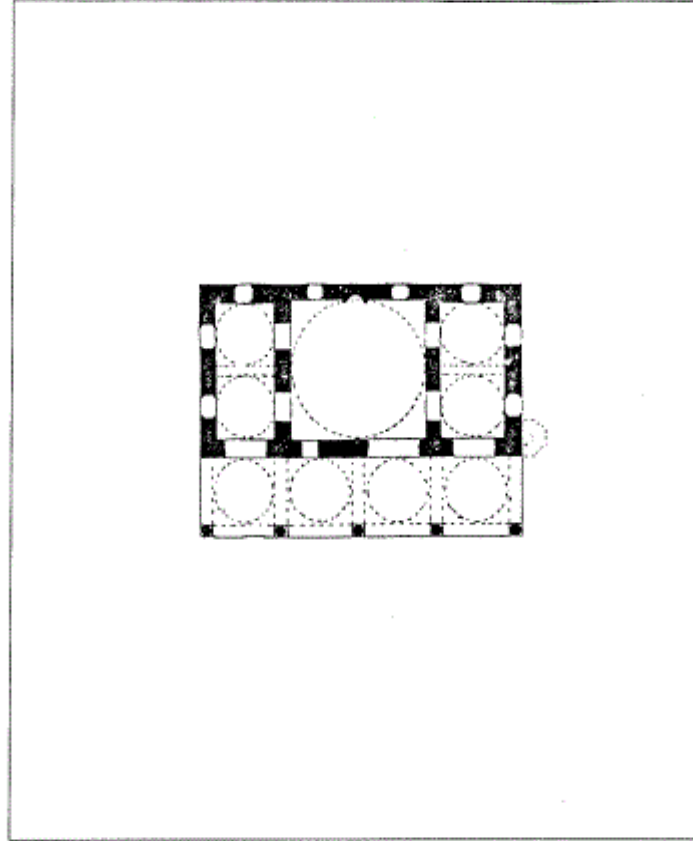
مسقط أفقي لمسجد اوج شرقي في أدنة (عن: ابهردي).
